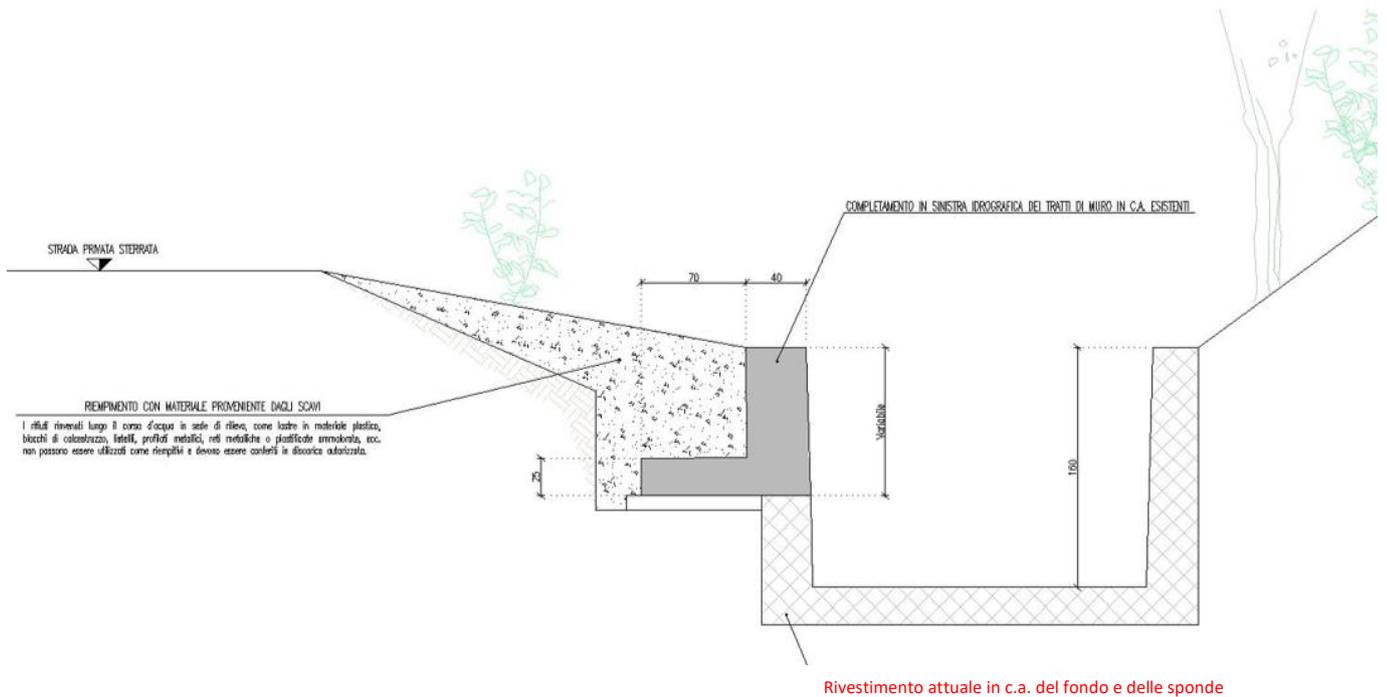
Sezione tipo con rifacimento muro in buono stato
